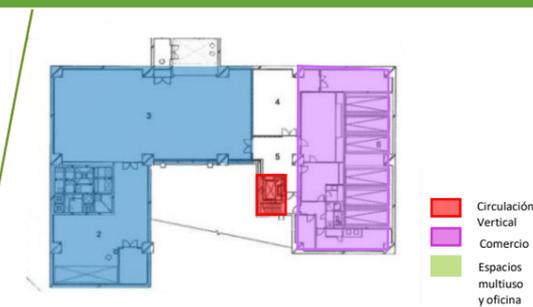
Planta Arquitectónica Subterránea Proyecto Osaka Gas NEXT-21
